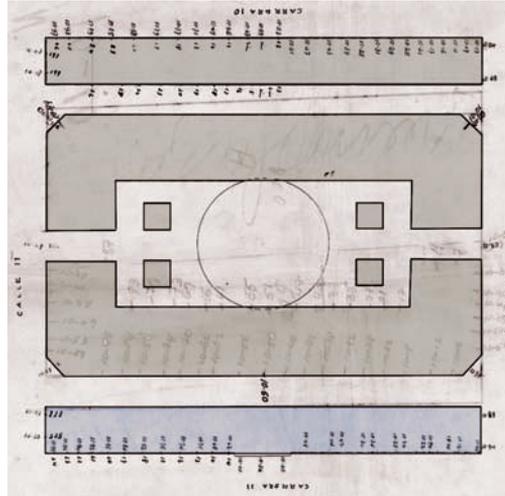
Levantamiento Catastral Plaza Central de Mercado, 1932. Archivo de Bogotá. Se indica en color azul el pabellón occidental diseñado y construido (parcialmente) por el Ingeniero Joaquín Fonseca, y en color gris, las áreas diseñadas por el arquitecto Pablo de la Cruz.
